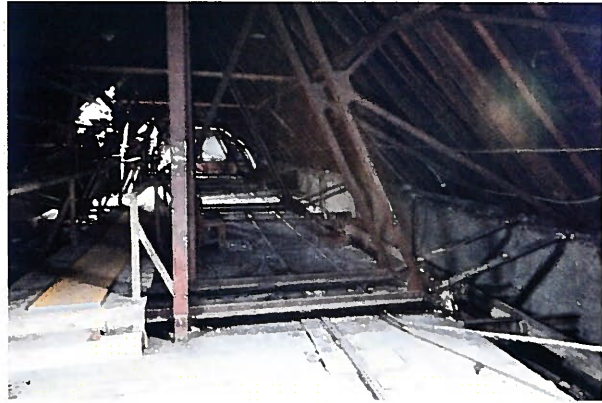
Dachraum über dem Festsaal, nach Norden, Sept. 2017
